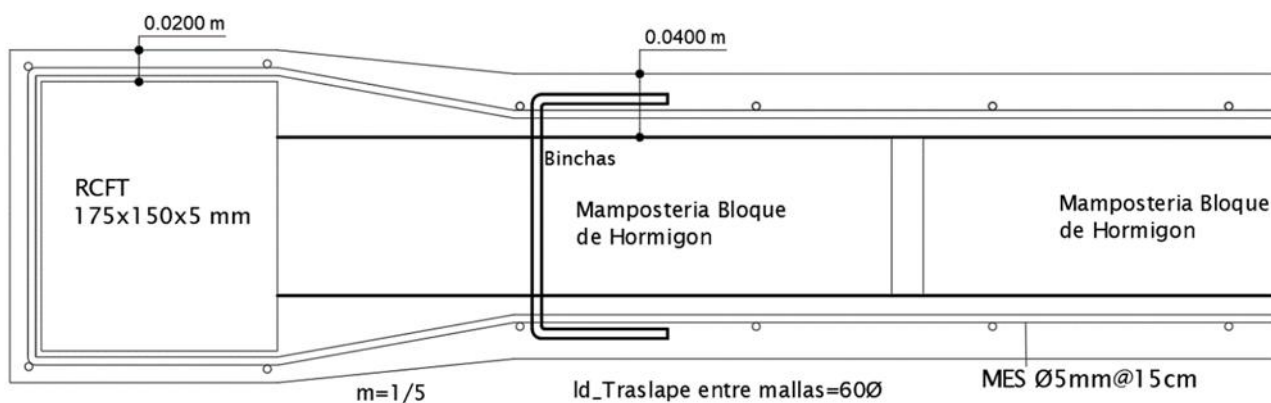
Esquema en planta de posible conexión entre columnas y enchape del prototipo I
